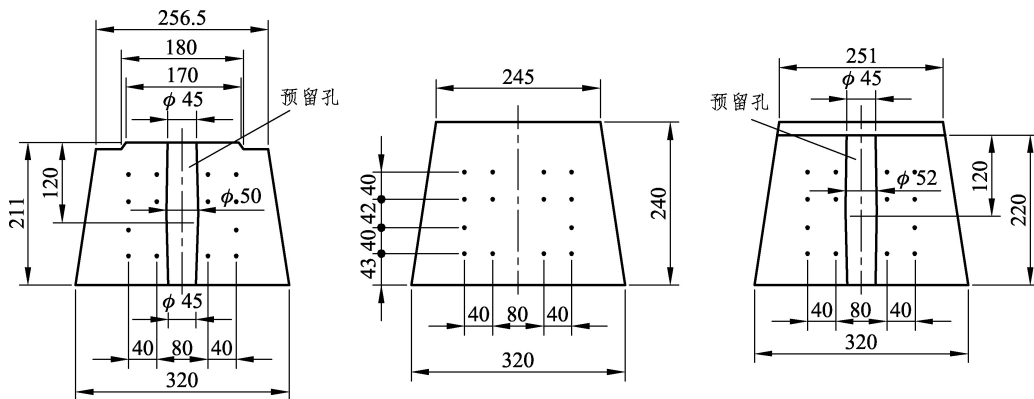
我国铁路新Ⅲ型混凝土桥枕（Ⅲqa）断面示意
